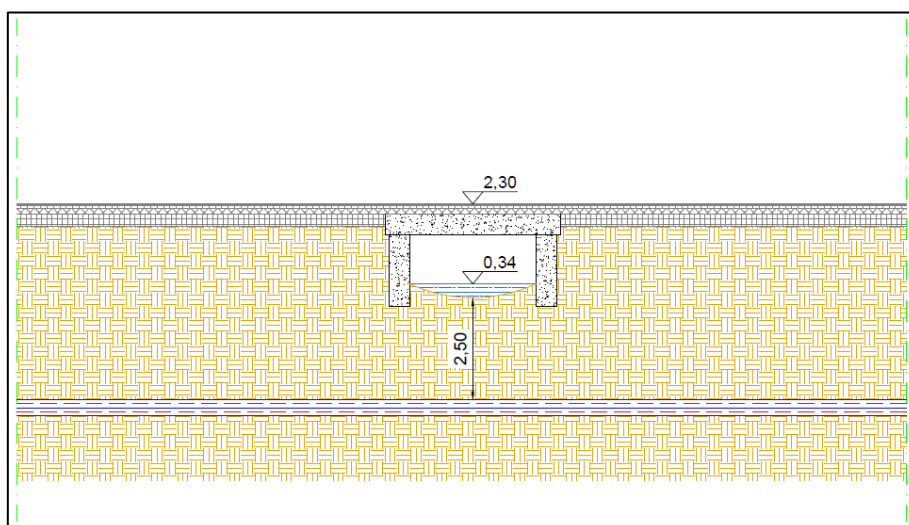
Profilo longitudinale tipo (estratto coldLI-PD-EG15-06-REV00)
